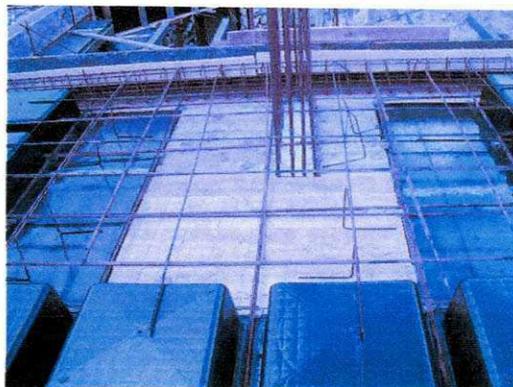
Ferragem das lajes e vigas. Figura 54. Ferragem das lajes e vigas.
